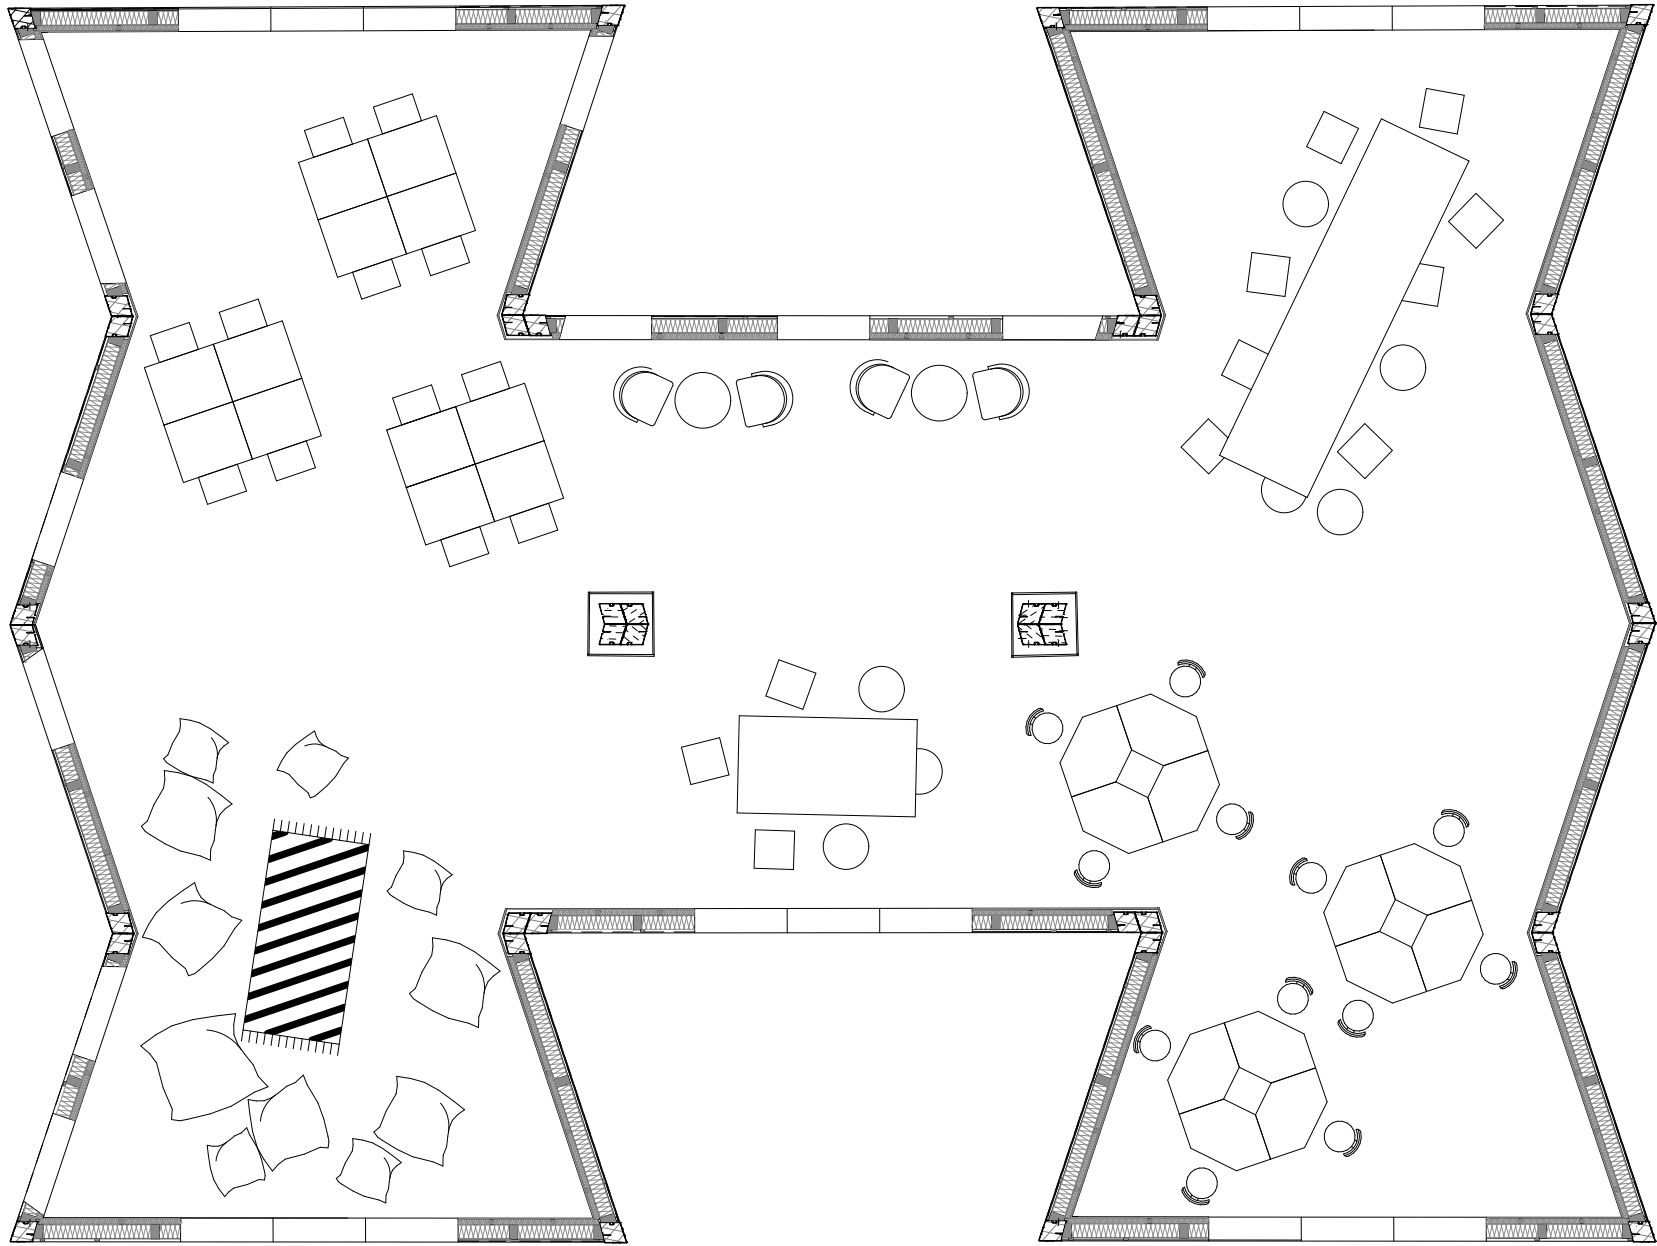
Grundriss Ausschnitt-Gruppenraum
